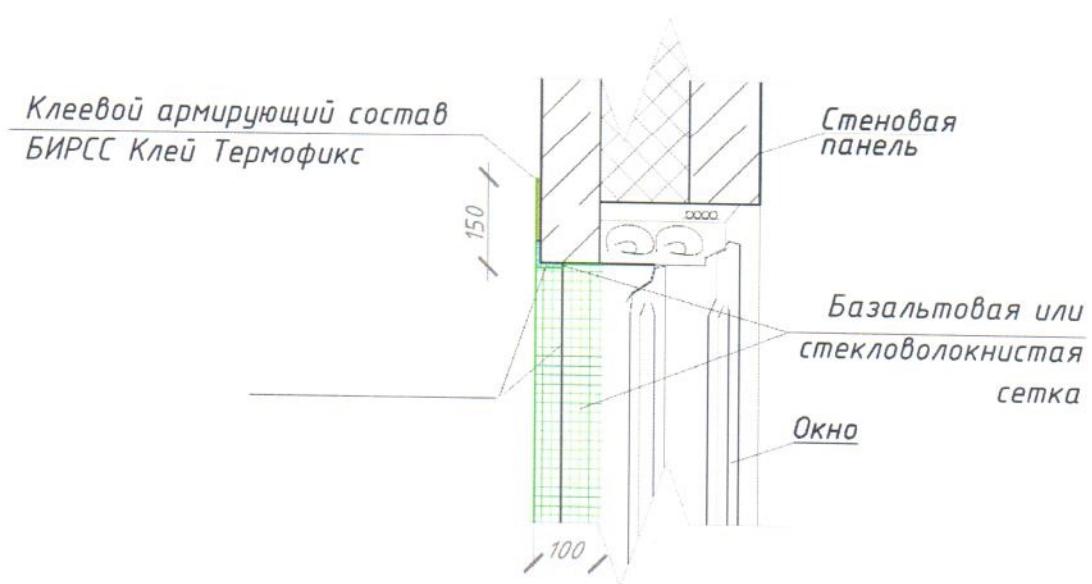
Армирование углов оконных откосов (разрез 1-1)
